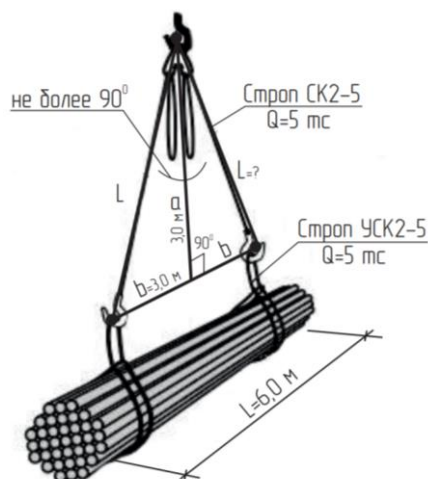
Схема строповки двухветвевым стропом арматуры
